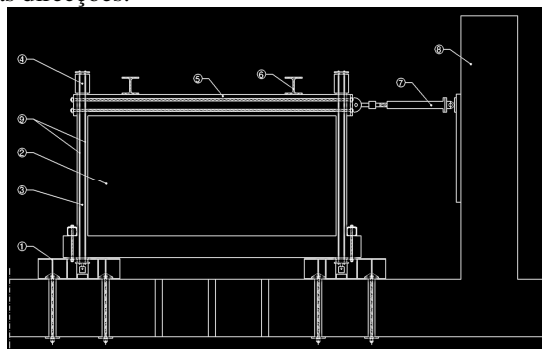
Infra-estrutura para o ensaio no plano. 1 - Bases metálicas; 2 - painel de alvenaria; 3 - Pórtico de betão armado; 4 - Actuador que permite traduzir as cargas do piso superior que actuam sobre os pilares; 5 - Tirantes de aço, que permitem a inversão do sentido de carga; 6 - Perfil metálico, ligado à laje de betão na base, que confere reacção aos actuadores verticais; 7 - Actuador horizontal servo-controlado, com capacidade para controle em deslocamento ou em força; 8 - Parede de reacção; 9 - Tirantes de reacção
